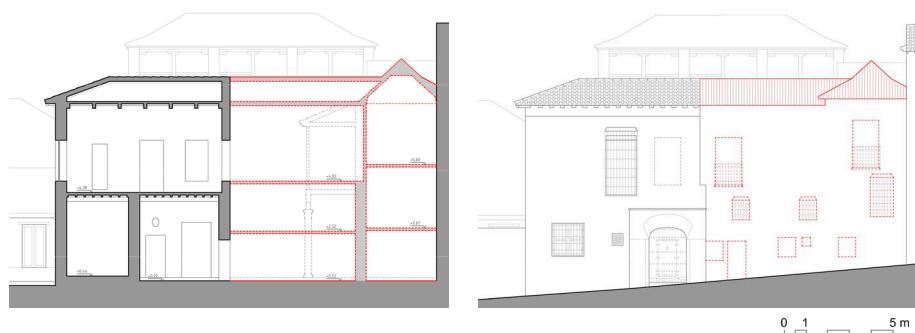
60b: Sección longitudinal de la crujía a fachada y restitución del alzado completo (ss. XIX-XX). Gloria 5, Granada.
